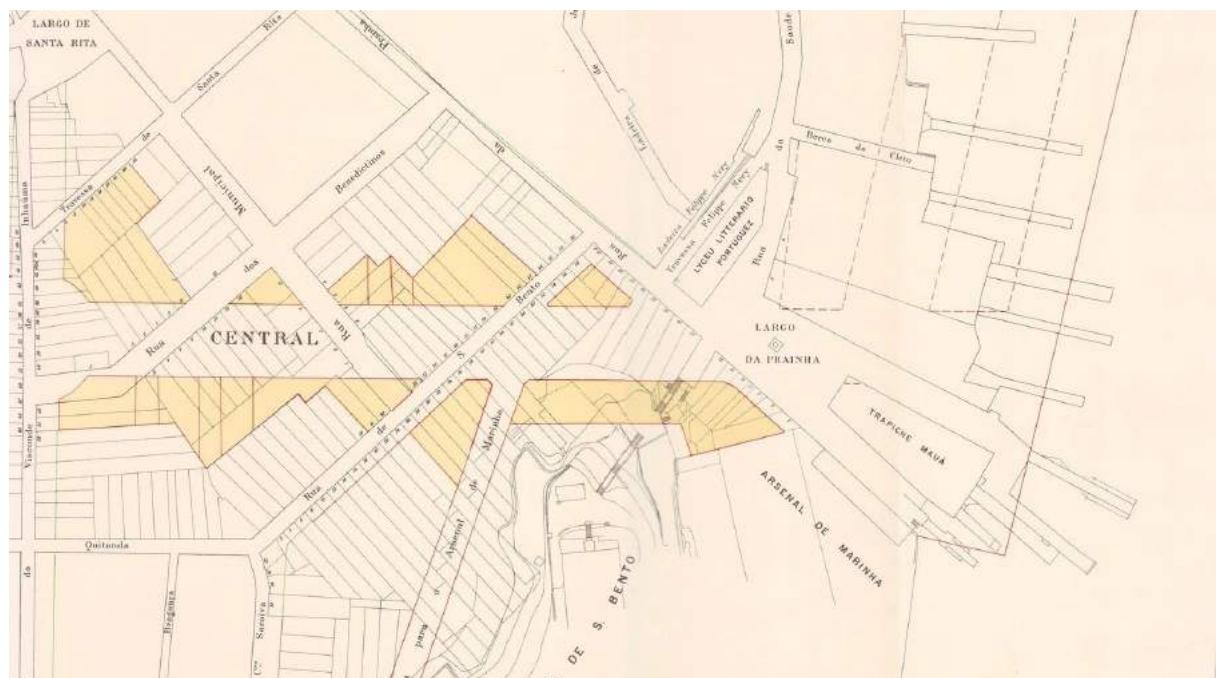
Detalhe da planta de demolições da abertura da Avenida Central, na altura da Praça Mauá, chamada até então de Largo da Prainha.
